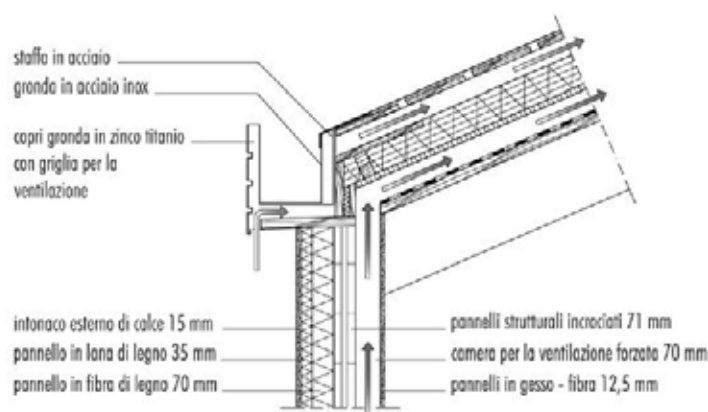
Dettaglio di parete di tamponamento e copertura in legno; la struttura è munita di cappotto esterno e camera di ventilazione forzata interna (ed intradossale nella copertura) distinta dalla ventilazione a circolazione naturale della copertura.
